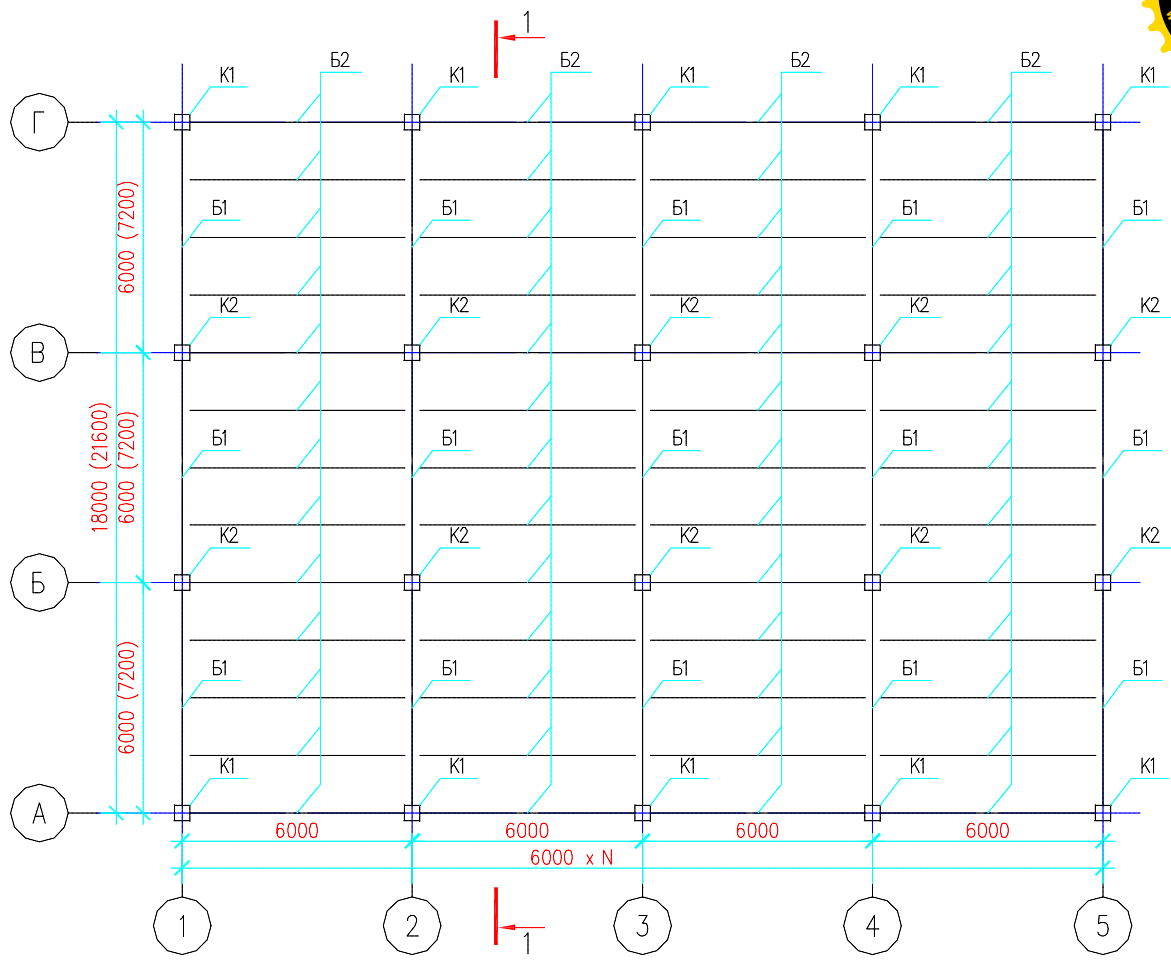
Схема расположения элементов каркаса железобетонного здания.
